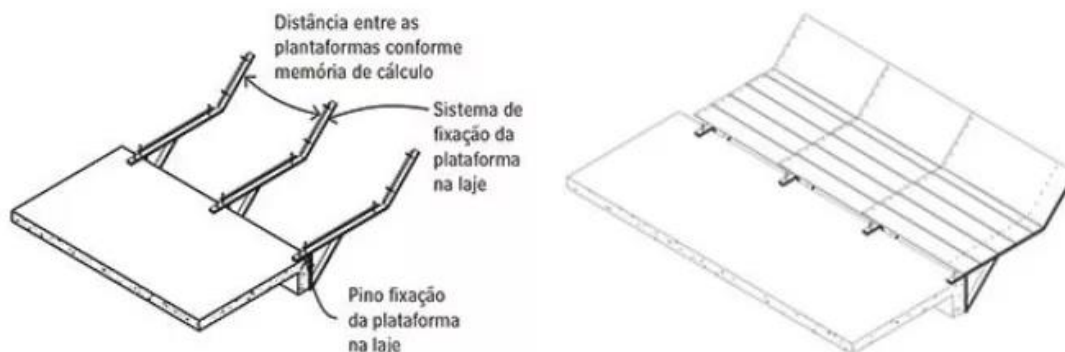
Fixação da plataforma de proteção em estrutura metálica
